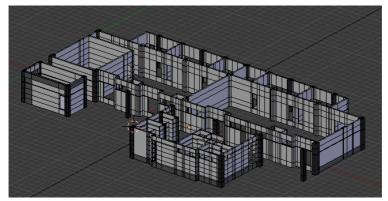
Contoh Peta pada Denah Wilayah Gedung Laboratorium lantai 1
